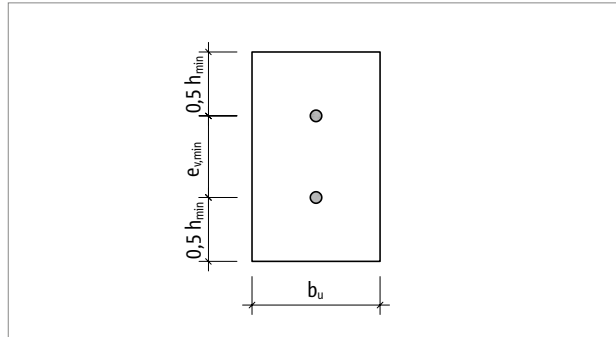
Schöck Stacon® Typ LD: Minimale Bauteilabmessungen und Dornabstände an der Stirnseite eines Balkens oder einer Wand
